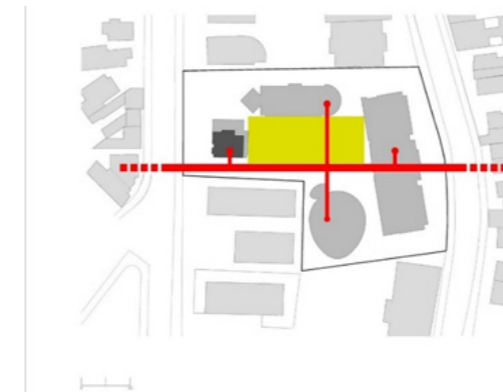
Planta esquemática do Edifício Praça Pamplona. Fonte: ArchDaily
